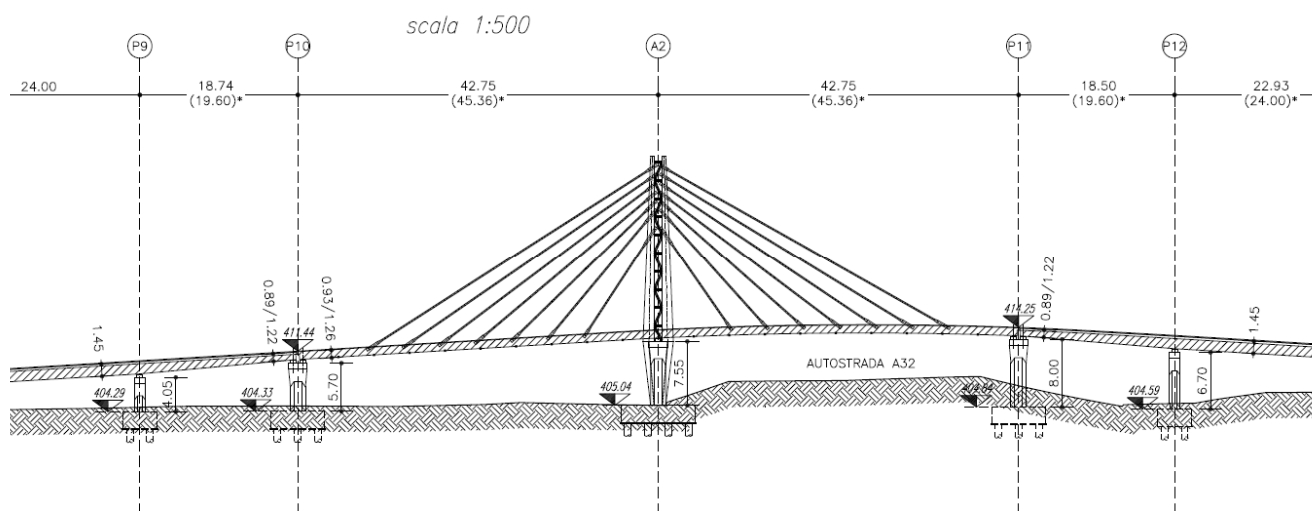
Stralcio del profilo dello svincolo - Sovrappasso in ingresso
